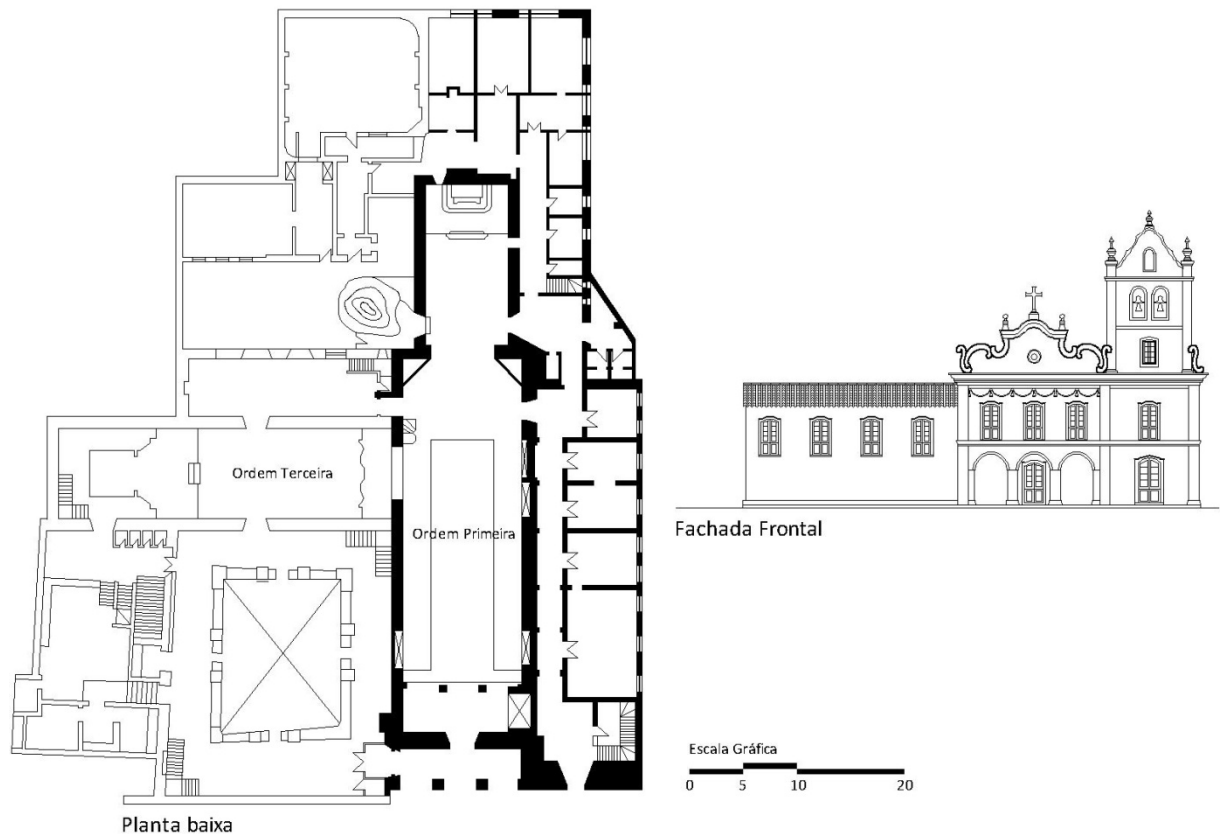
Planta e fachada da Igreja e Capela do Valongo– desenho M. Monte Mór
